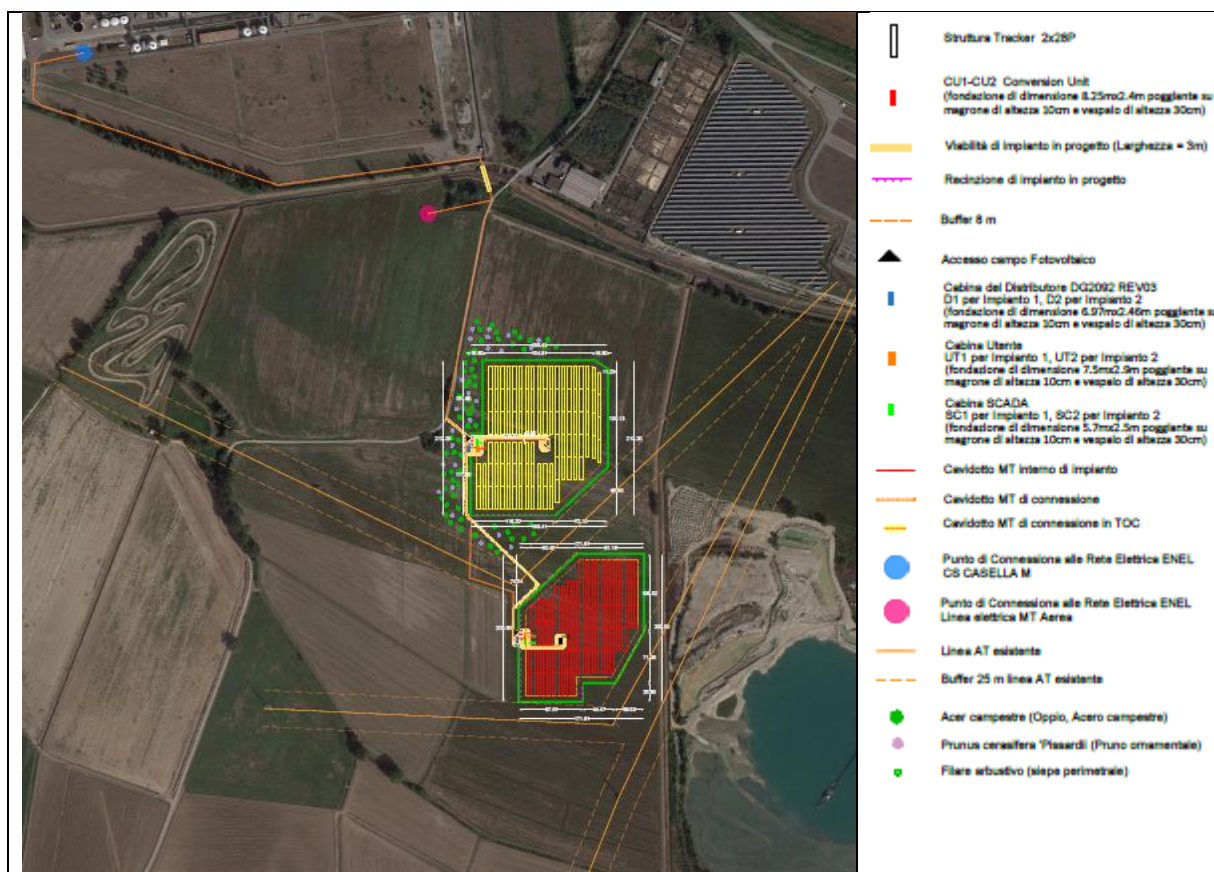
Layout generale d'impianto (stralcio da GRE.EEC.D.21.IT.P.12082.00.099.01)
